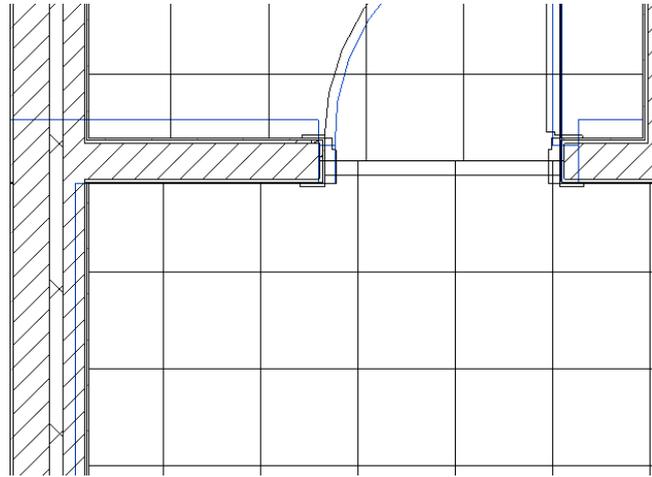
Espesores diferentes en muros de Planta Tipo, 2014.
